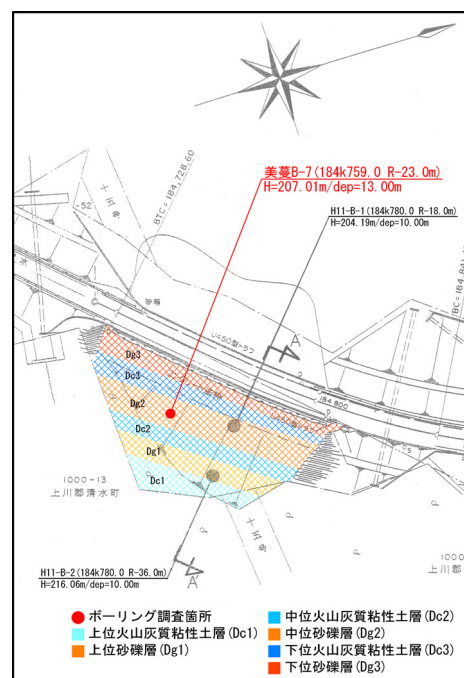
計測箇所近傍地質平面図(s=1:1,000)
